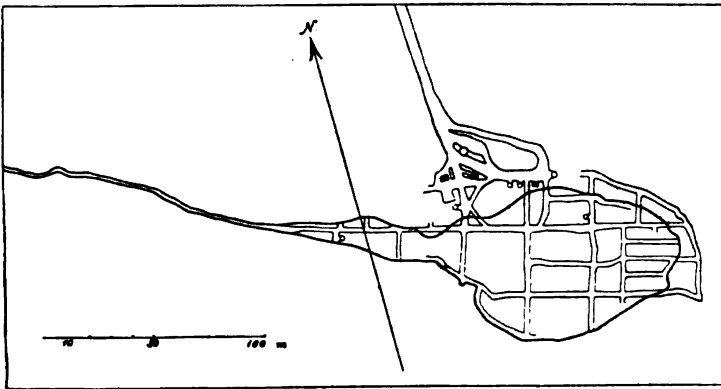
Grundriß der Kimberley Pipe in 648 m Tiefe.
